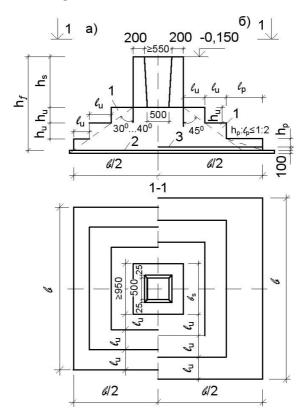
Монолитные железобетонные столбчатые фундаменты стаканного типа: a — жёсткий;  $\delta$  — жёсткий с нижней гибкой ступенью-плитой; 1 — фундамент; 2 — бетонная подготовка; 3 — арматурная сетка
